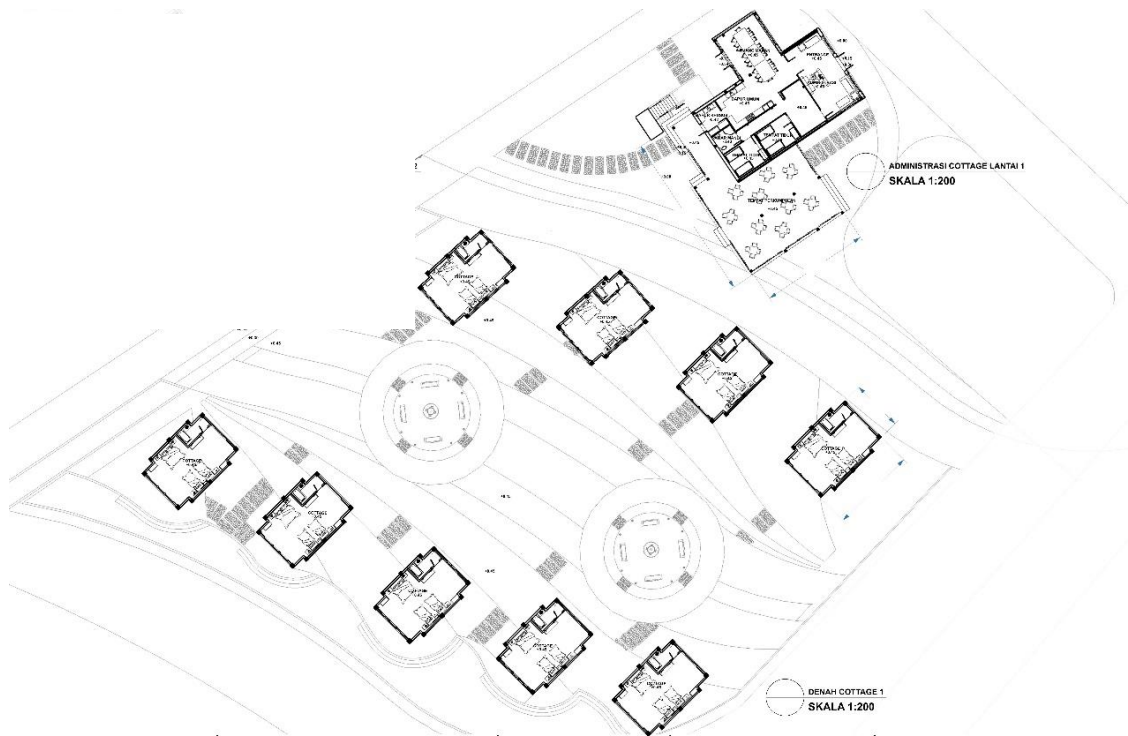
7 Denah lantai -1 (Zona Penerima dan Area Makan)
